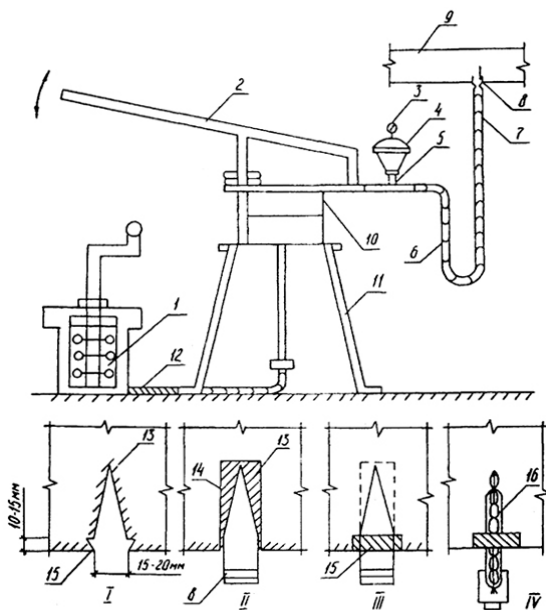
Ремонт трещин в бетонных и железобетонных конструкциях:
